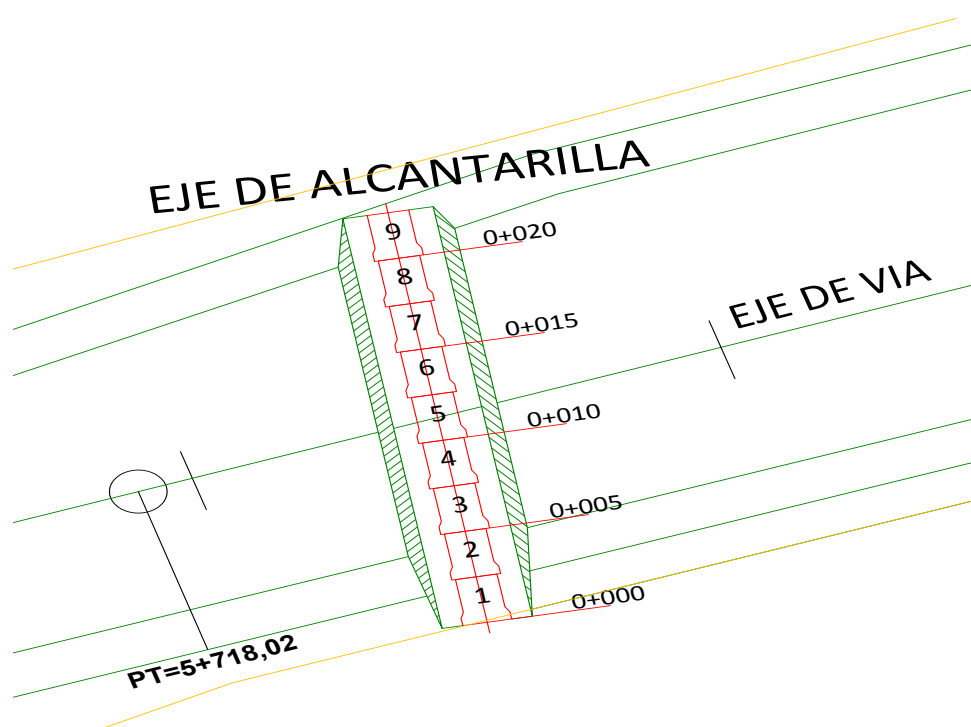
Vista en planta de la excavación y ubicación de la tubería en la alcantarilla 5+800,00
